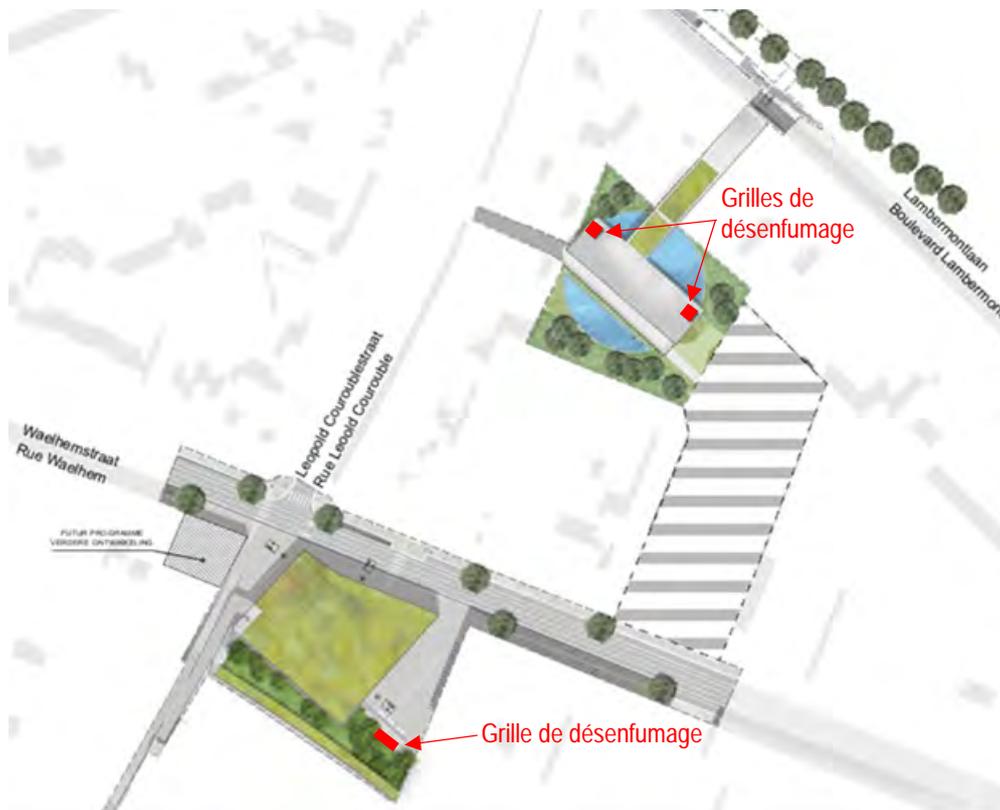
Localisation des grilles de désenfumage de la station (ARIES sur fond BMN, 2020)
